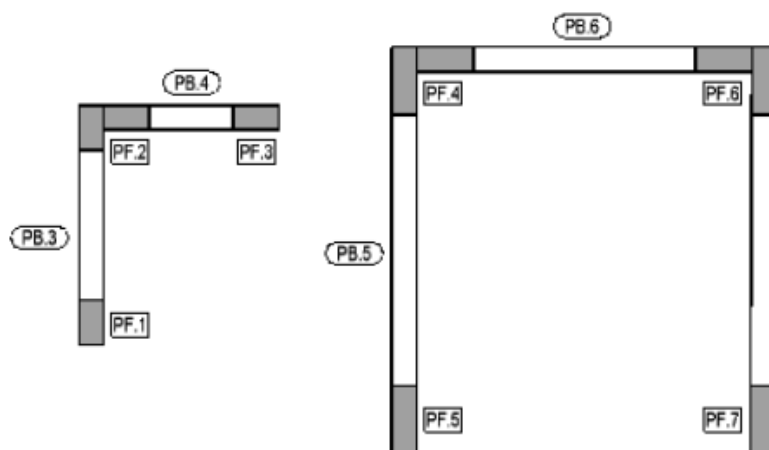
Esquema ilustrativo para o cálculo das paredes do núcleo do elevador e caixa de escadas da cave.
